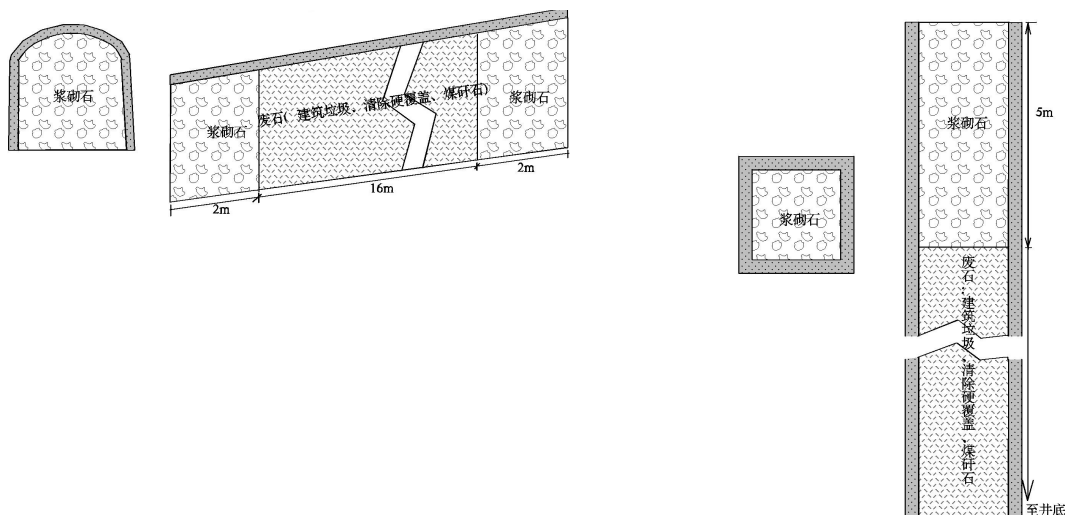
斜井井口封堵施工横、纵剖面示意图 图 5-2 竖井井口封堵施工横、纵剖面示意图
